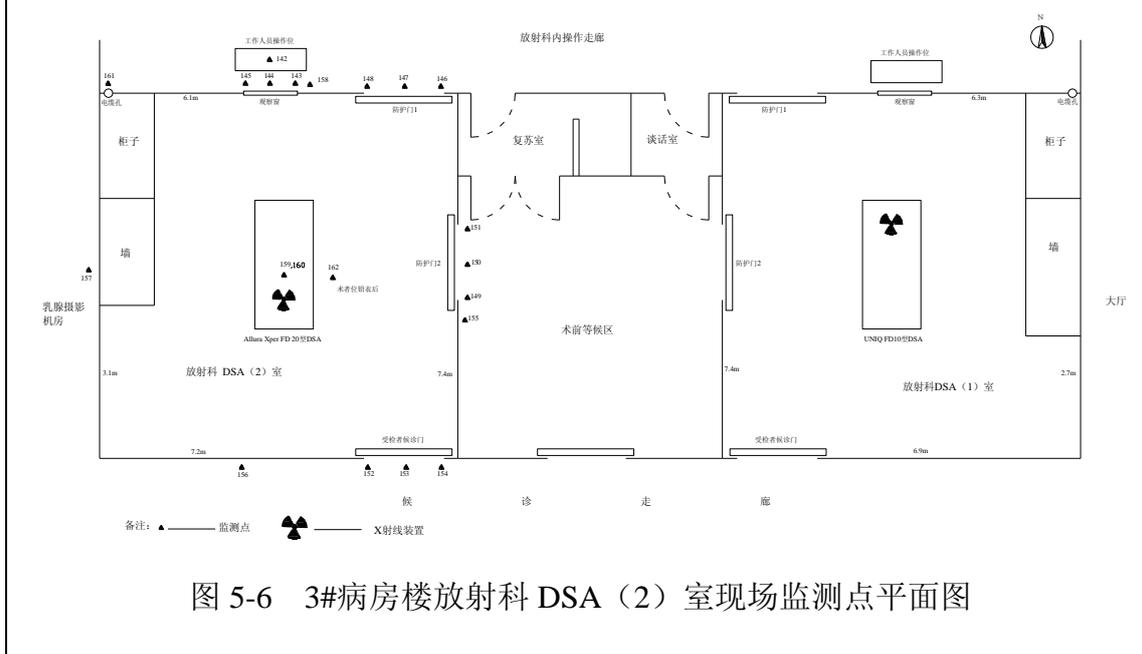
3#病房楼放射科 DSA (2) 室现场监测点平面图
